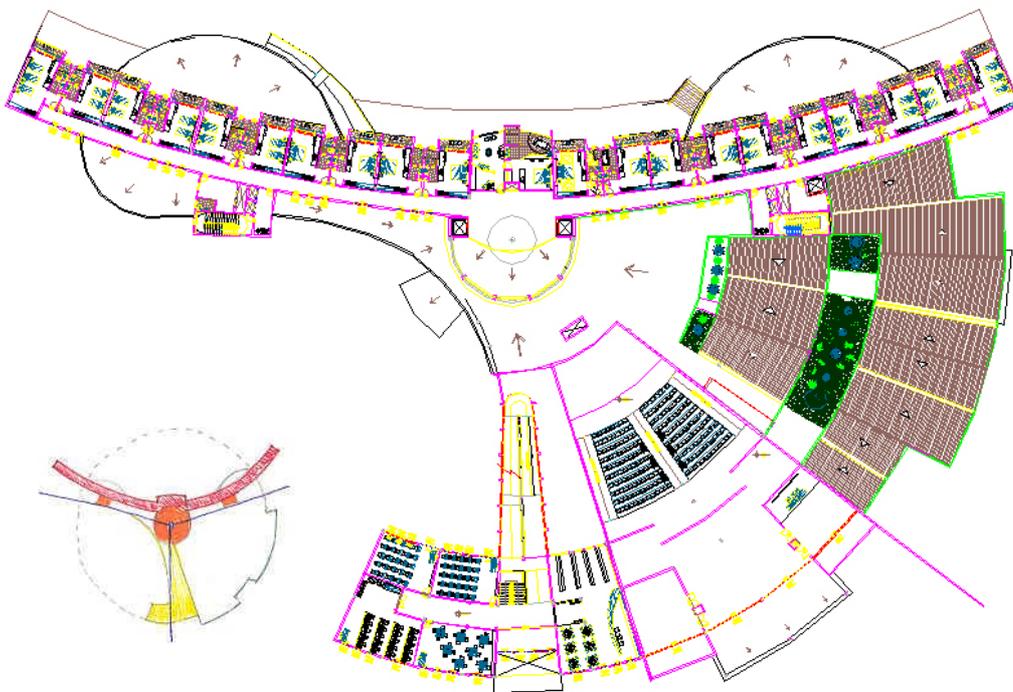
Planta Baixa Mobiliada Pav. Tipo, sem escala.
